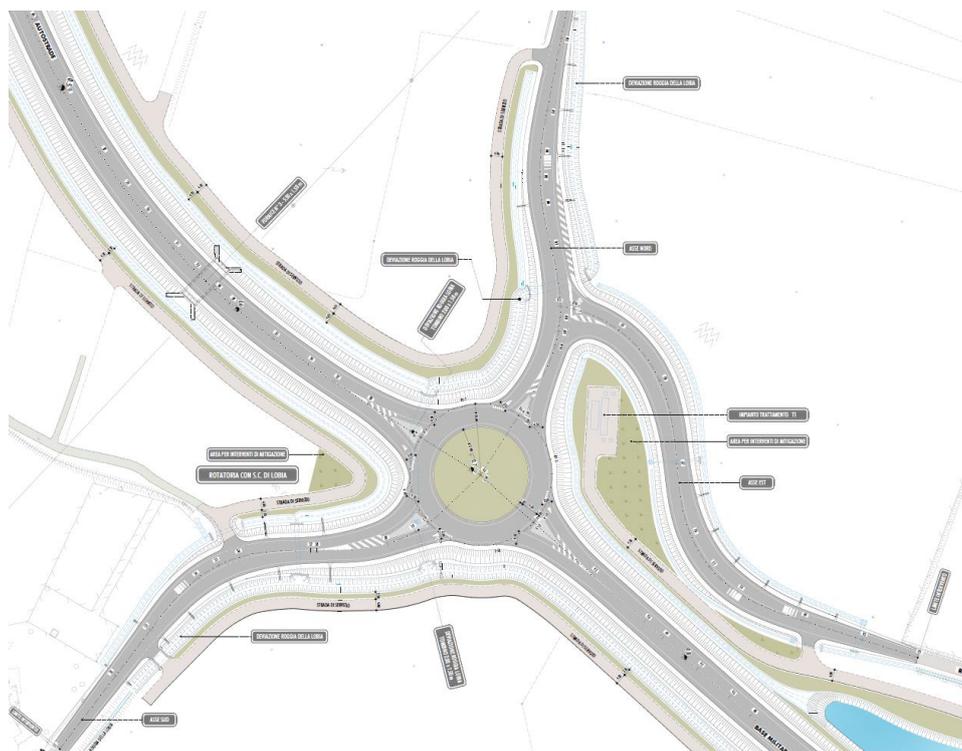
Intersezione a rotatoria con S.C. Lobia – stralcio planimetrico
